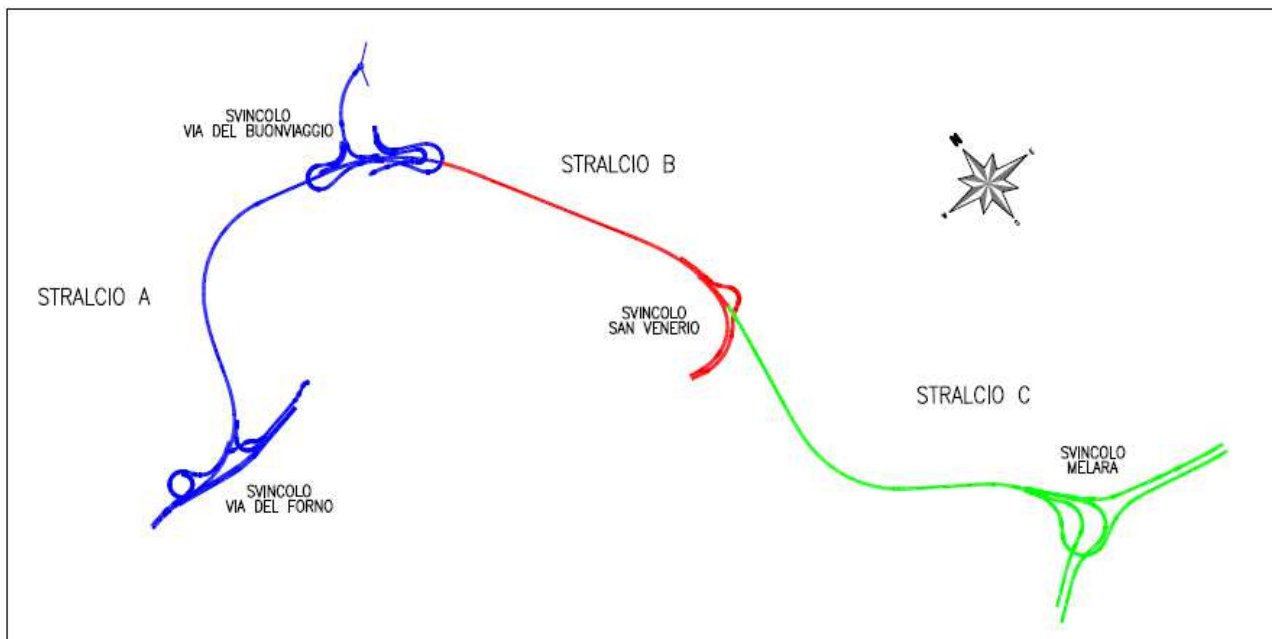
Planimetria Lotto 3 - Suddivisione in Stralci funzionali
